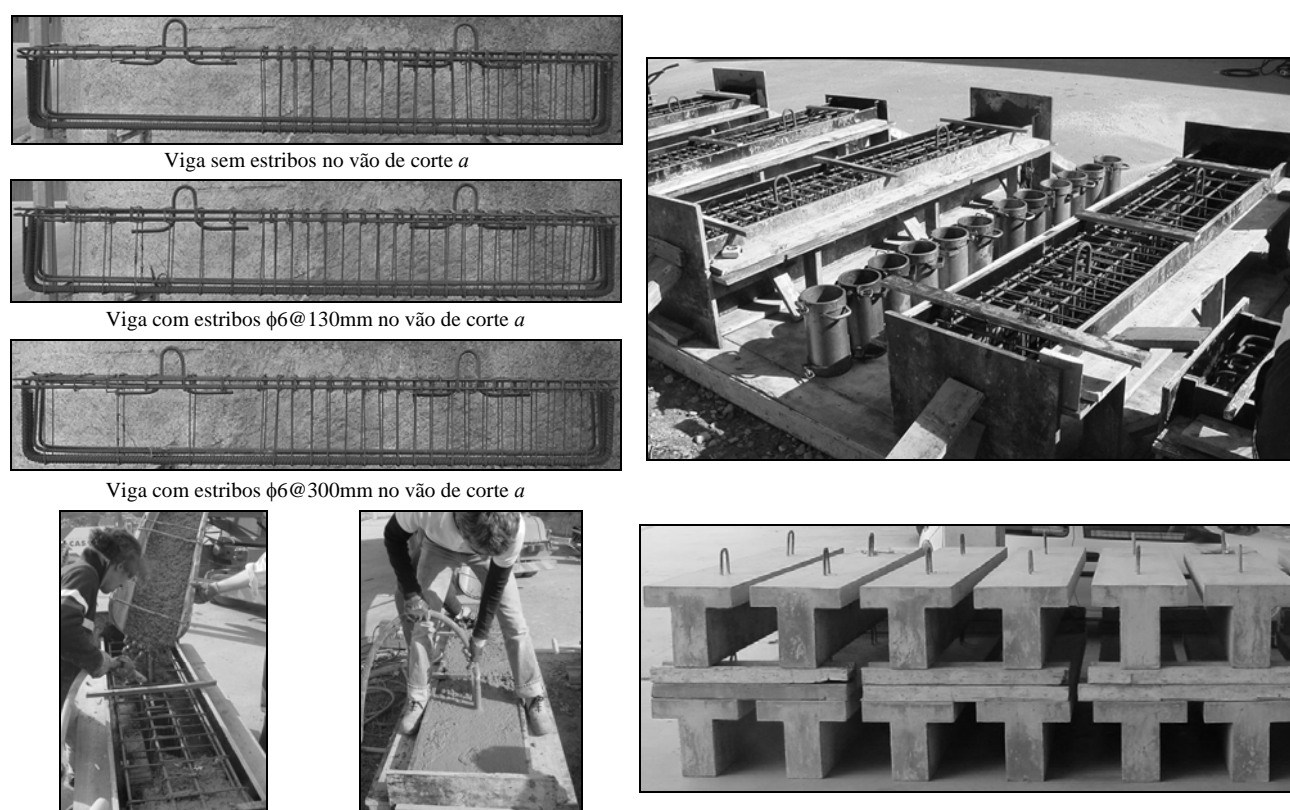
Execução e armazenamento das vigas ensaiadas na série A.
